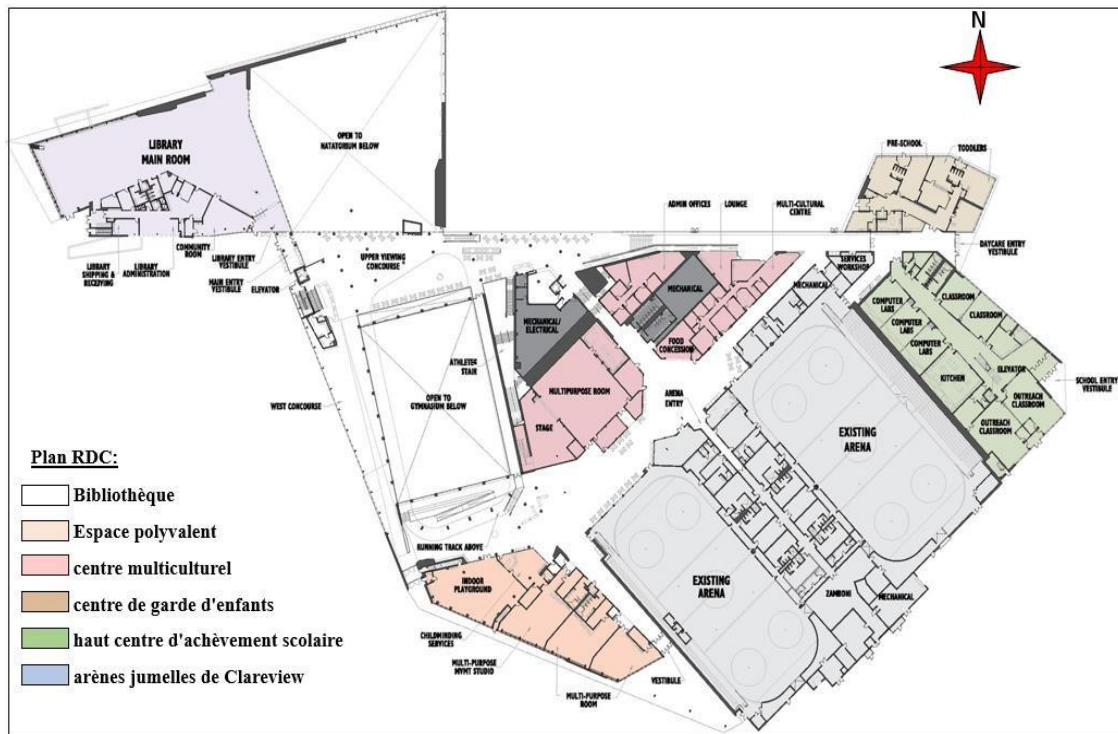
Plan de RDC du centre de loisirs de Clareview. (Source : Archdaily.com)
